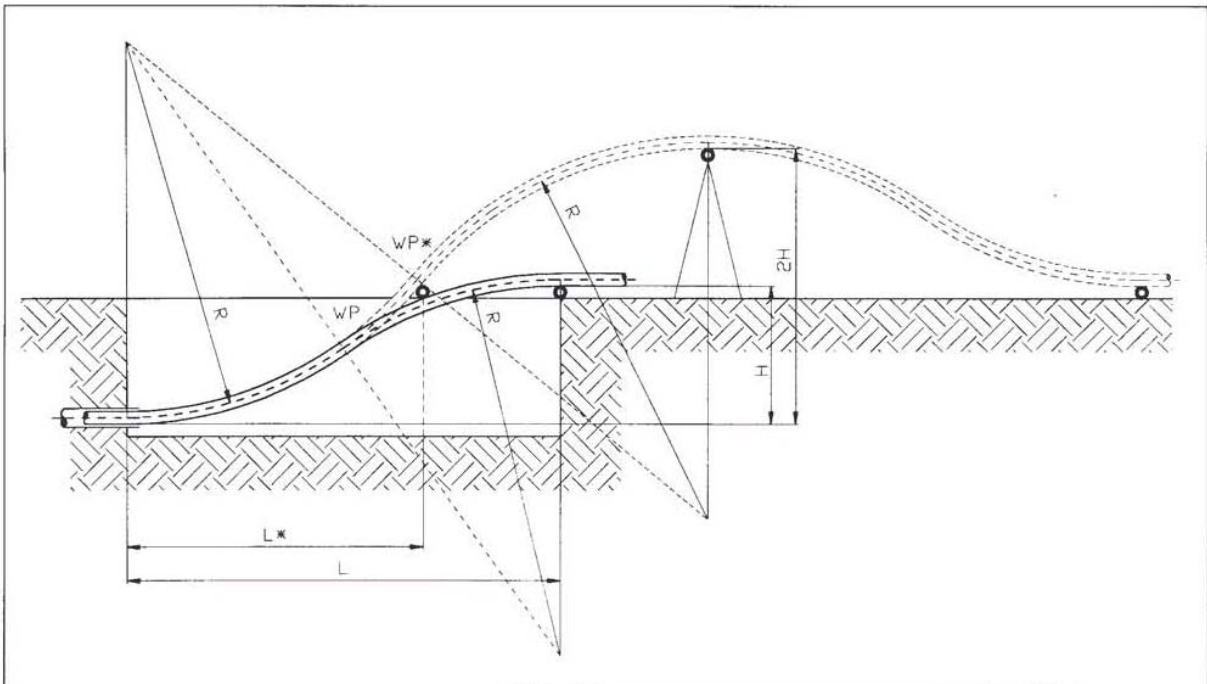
Berechnung der Länge einer Baugrube (Quelle: DVGW-Arbeitsblatt GW 320-2)
